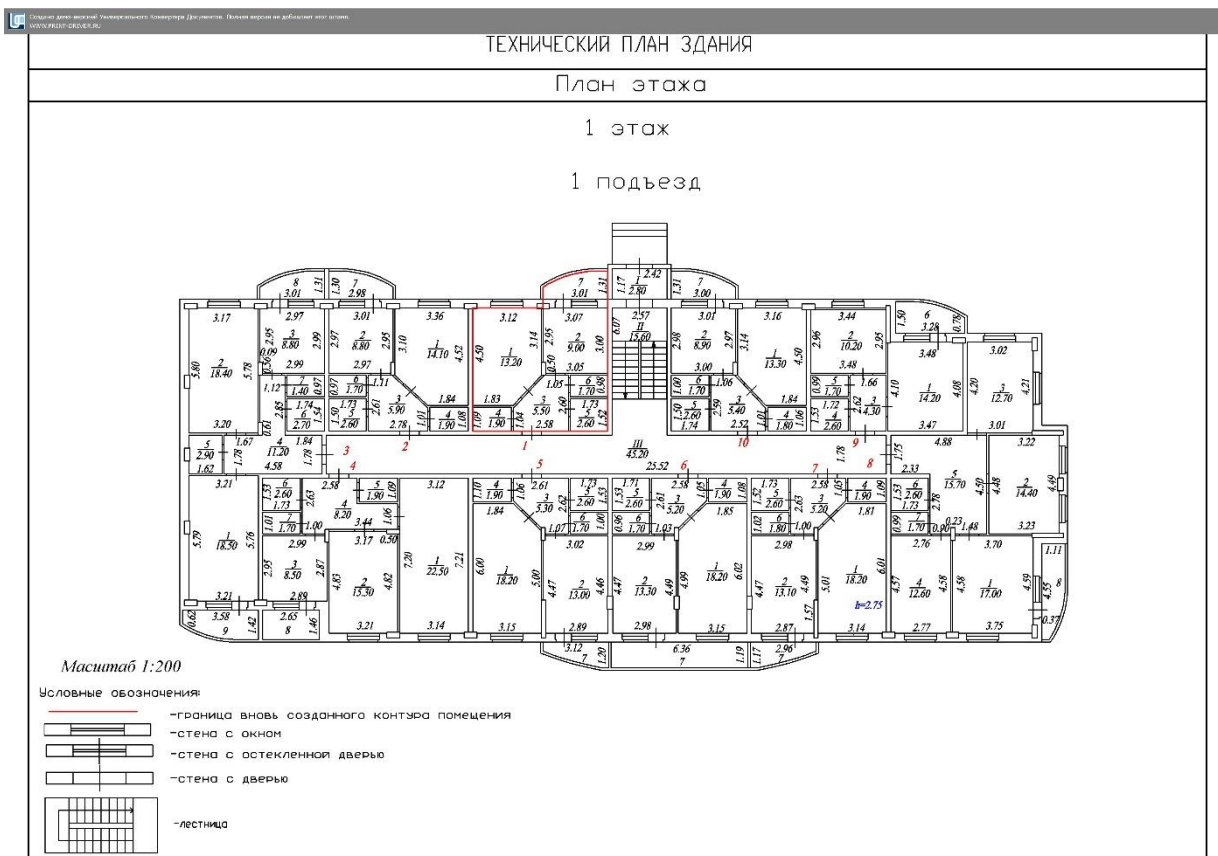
Фрагмент технического плана здания и плана первого этажа
